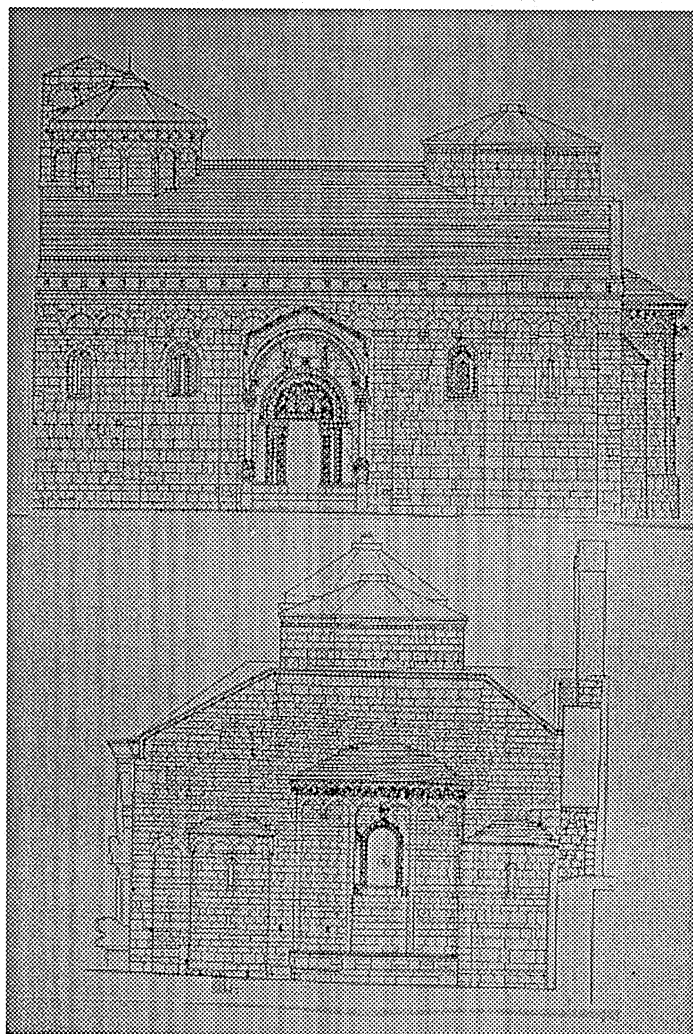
San Leonardo, (in alto) prospetto settentrionale; (in basso) prospetto absidale (rilievi arch. A. D'Ardes).
